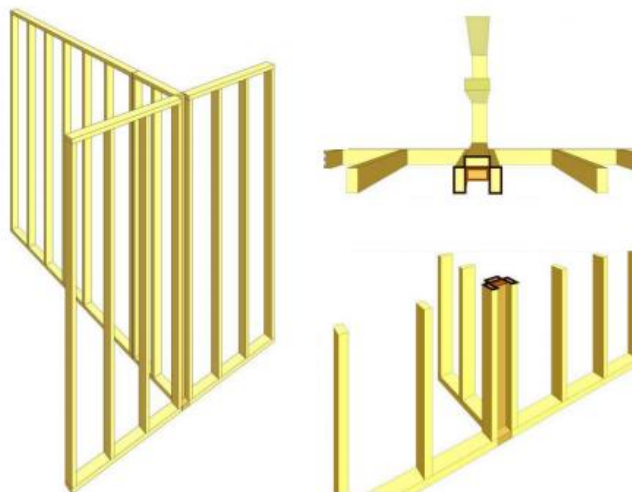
Pomenorização do encontro perpendicular entre três painéis de parede [6]
